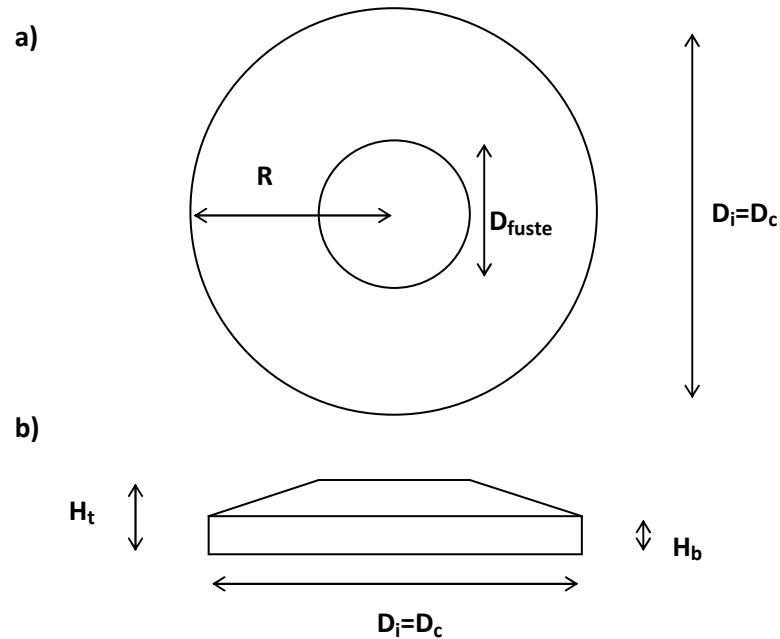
Zapata circular: a) vista en planta, b) vista en alzado.
